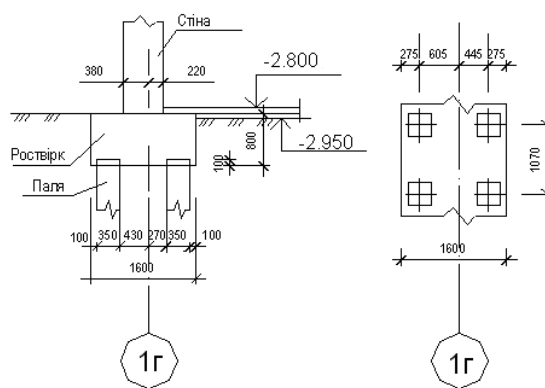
Конструкція пального фундаменту по вісі 1г
